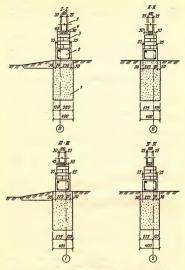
Конструкция цоколя и ленточного фундамента: 1 — песчаная подушка; 2 — ленточный железобетонный фундамент; 3 — кирпичный цосков; 4 — брусок нижней обевзяк; 5 — стона
